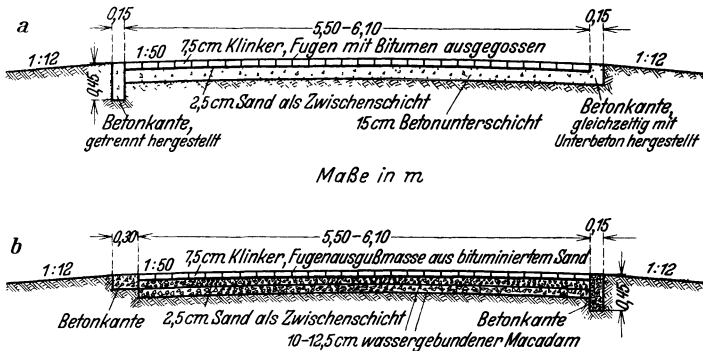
Regelquerschnitte des Bureau of Public Roads für Klinkerdecken. a) auf Betonunterlage, b) auf wassergebundenem Makadam [E 4].
